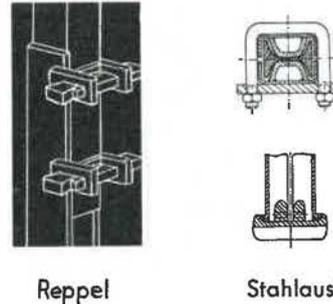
droite : Pied de cadre coulissant Stahlausbau.
